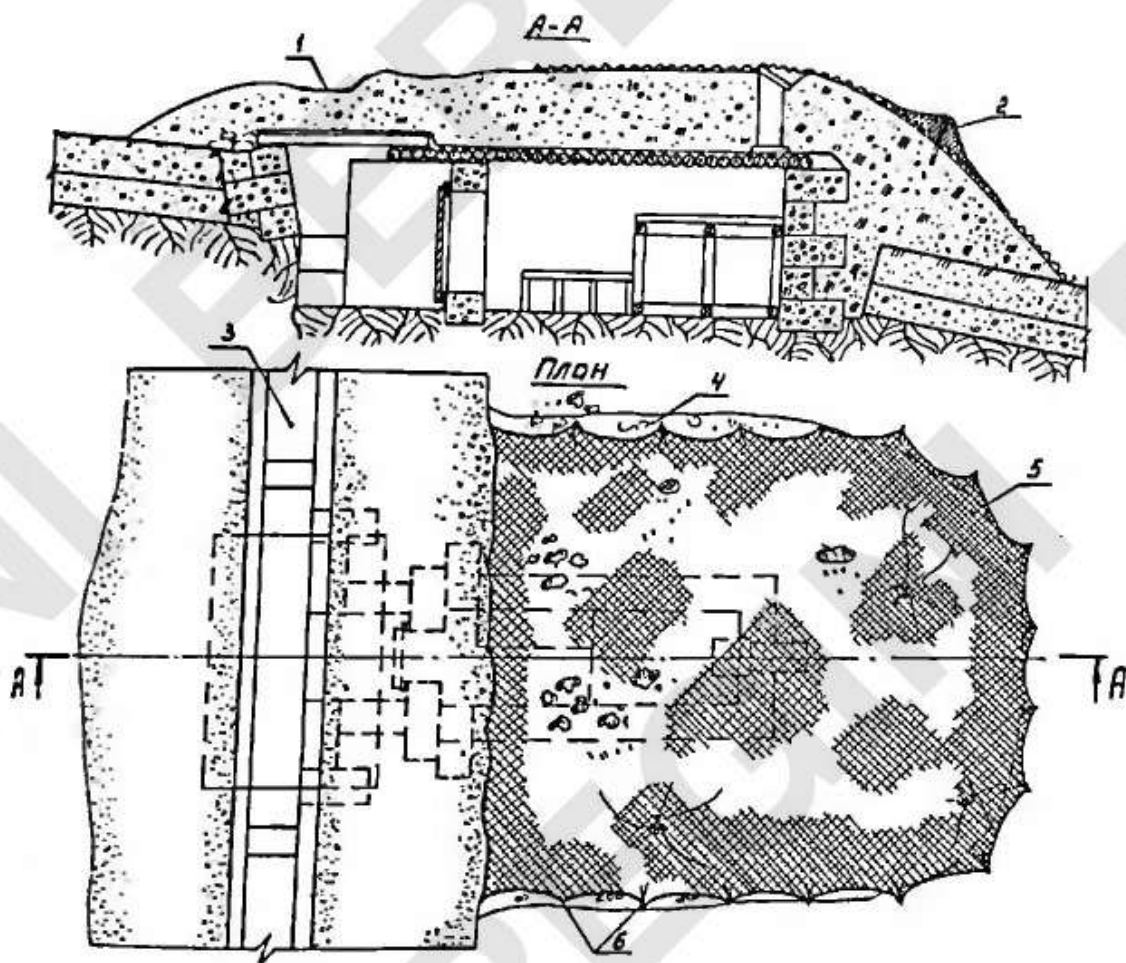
Б'юнджак із залізобетонних елементів (розріз):
